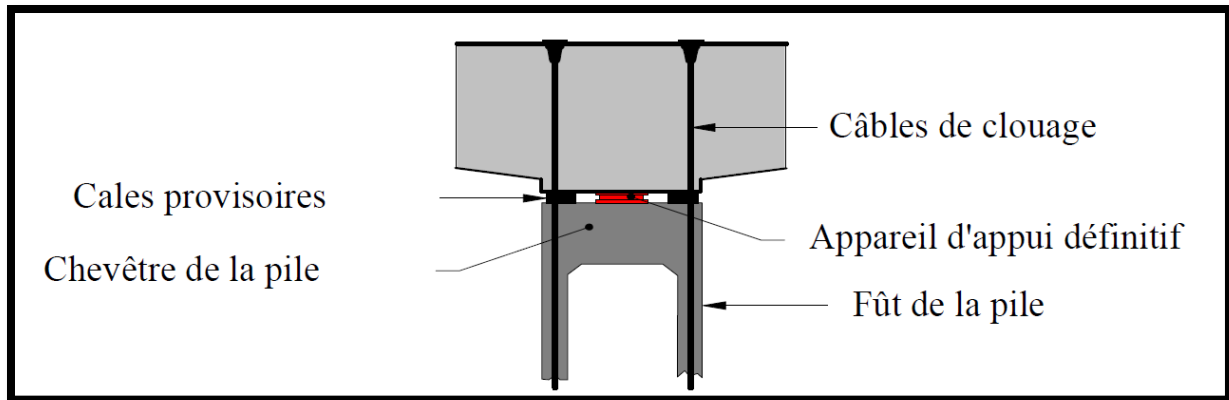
Schéma de clouage sur pile par câbles provisoires.
